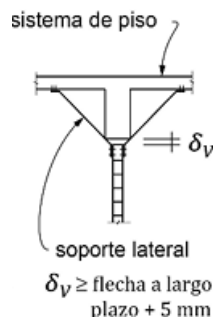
Holgura vertical entre muro no estructural y losa. Obtenido de NTC mampostería de 2017.
